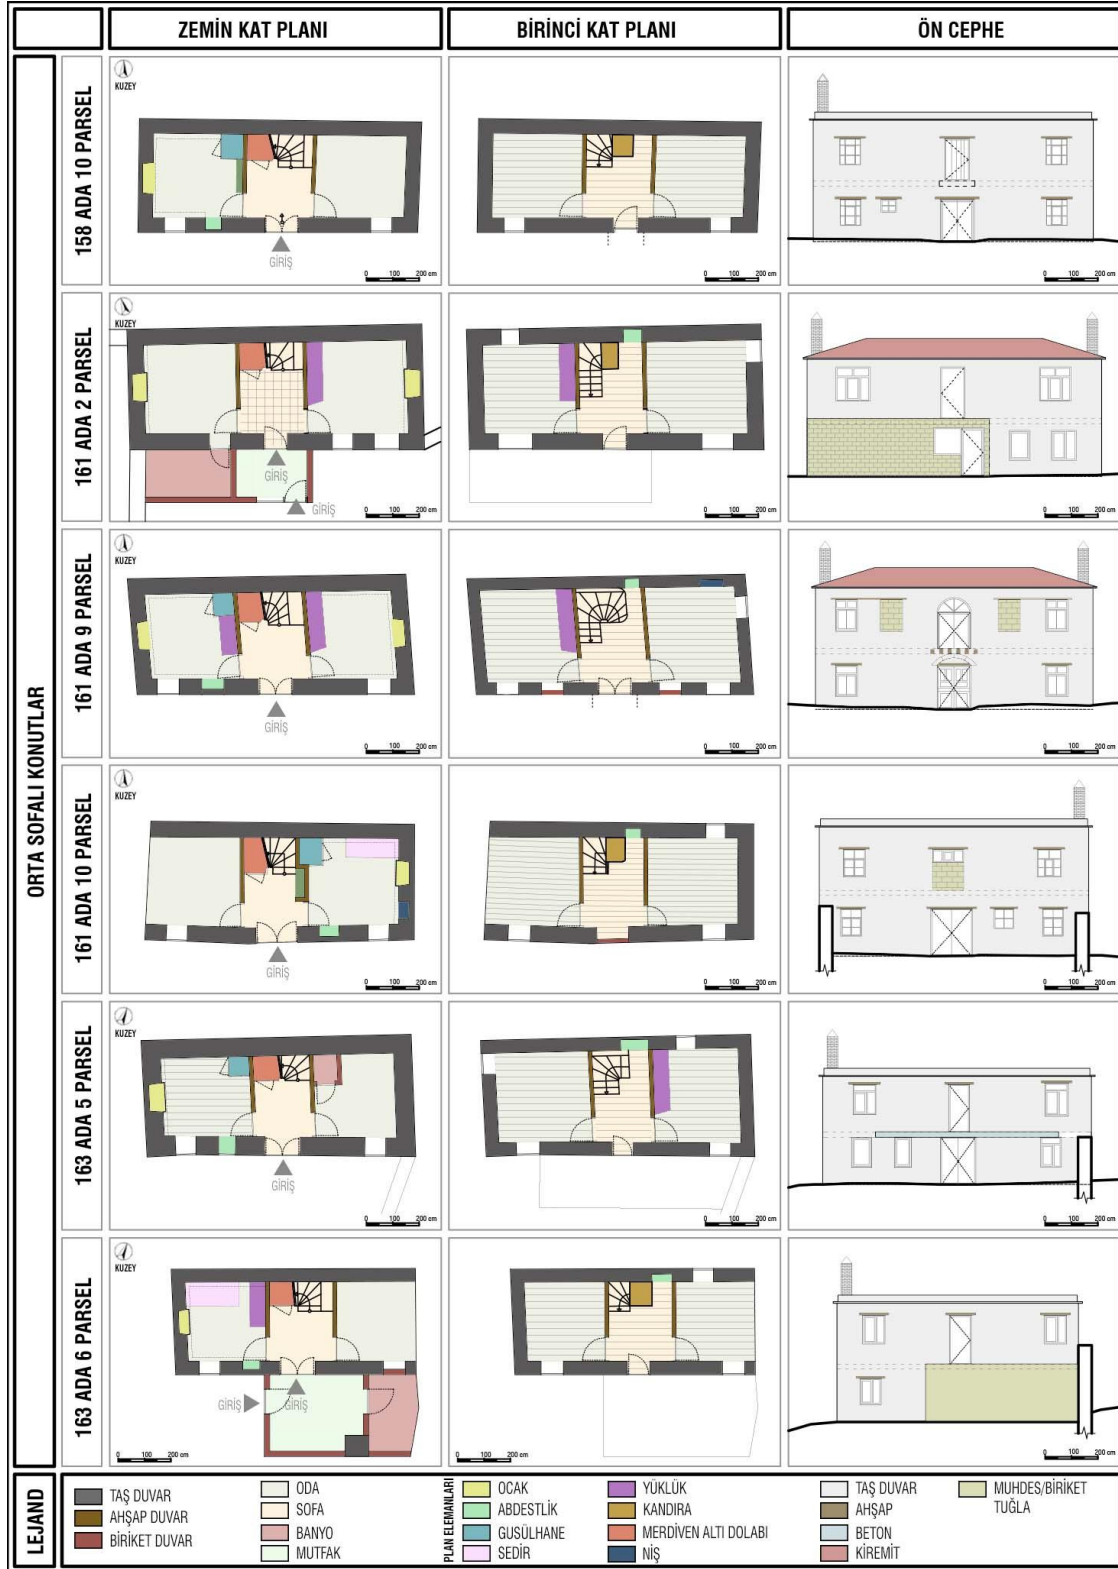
Plan Elemanları (İ. Çeliker - 2021)
